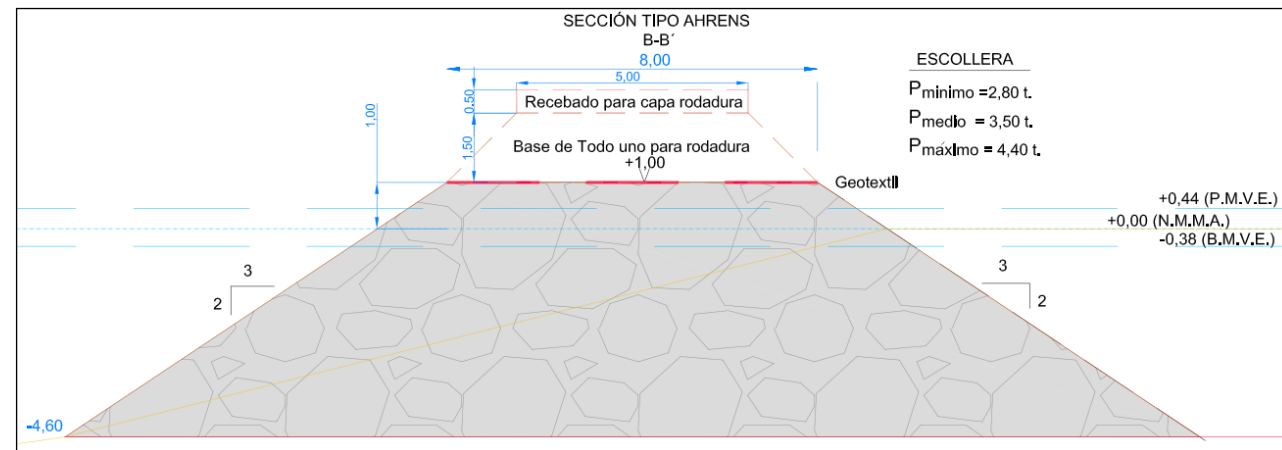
Sección tipo espigón en tramo emergido, con obra provisional de acceso para ejecución.
